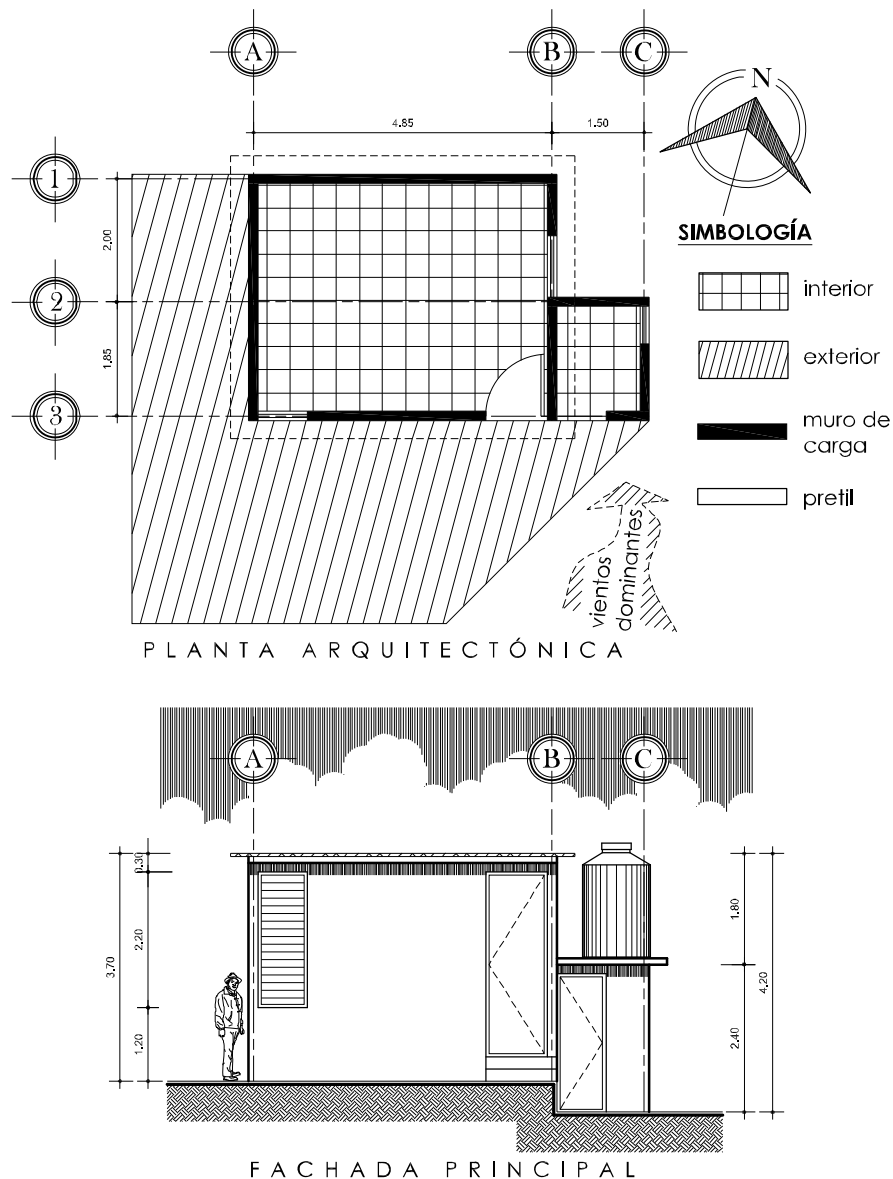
VIVIENDA 2 FUENTE: Levantamiento realizado por Alejandro Ocampo Arcos.
